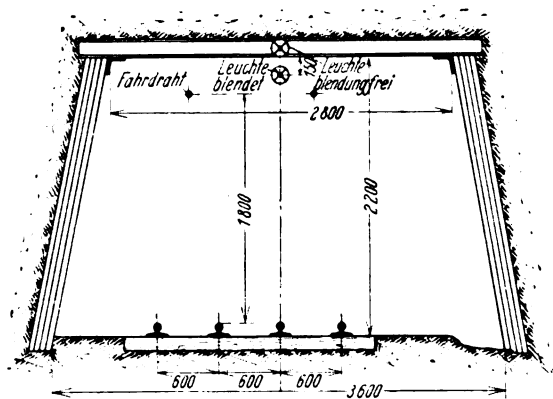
Grubenstrecke mit eingebauten Leuchten.
